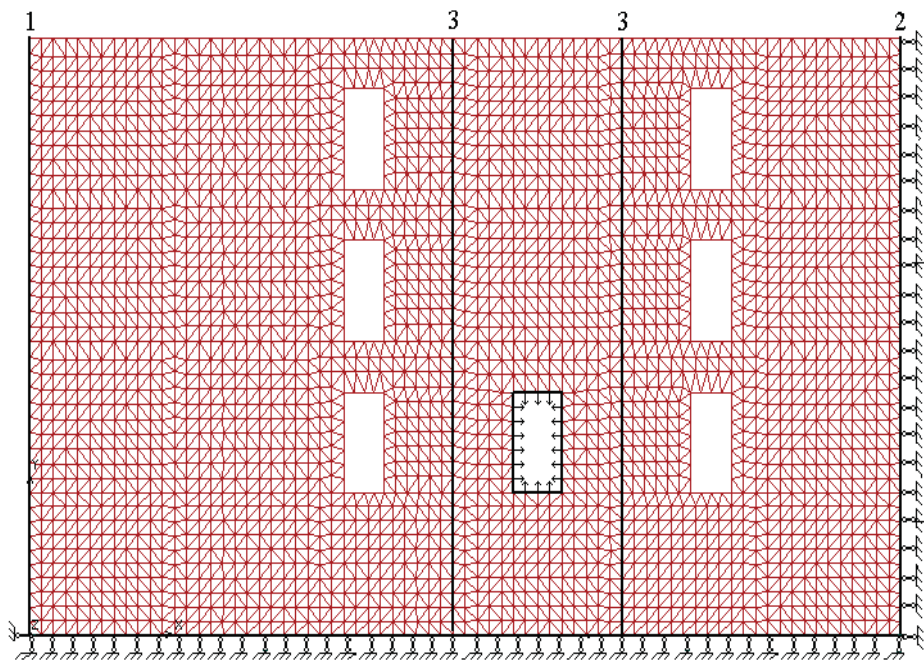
Расчетная схема внутренней продольной стены при исследованиях изменения НДС, вызванных устройством проема: 1 – 3 – стержневые КЭ, моделирующие поперечные стены
